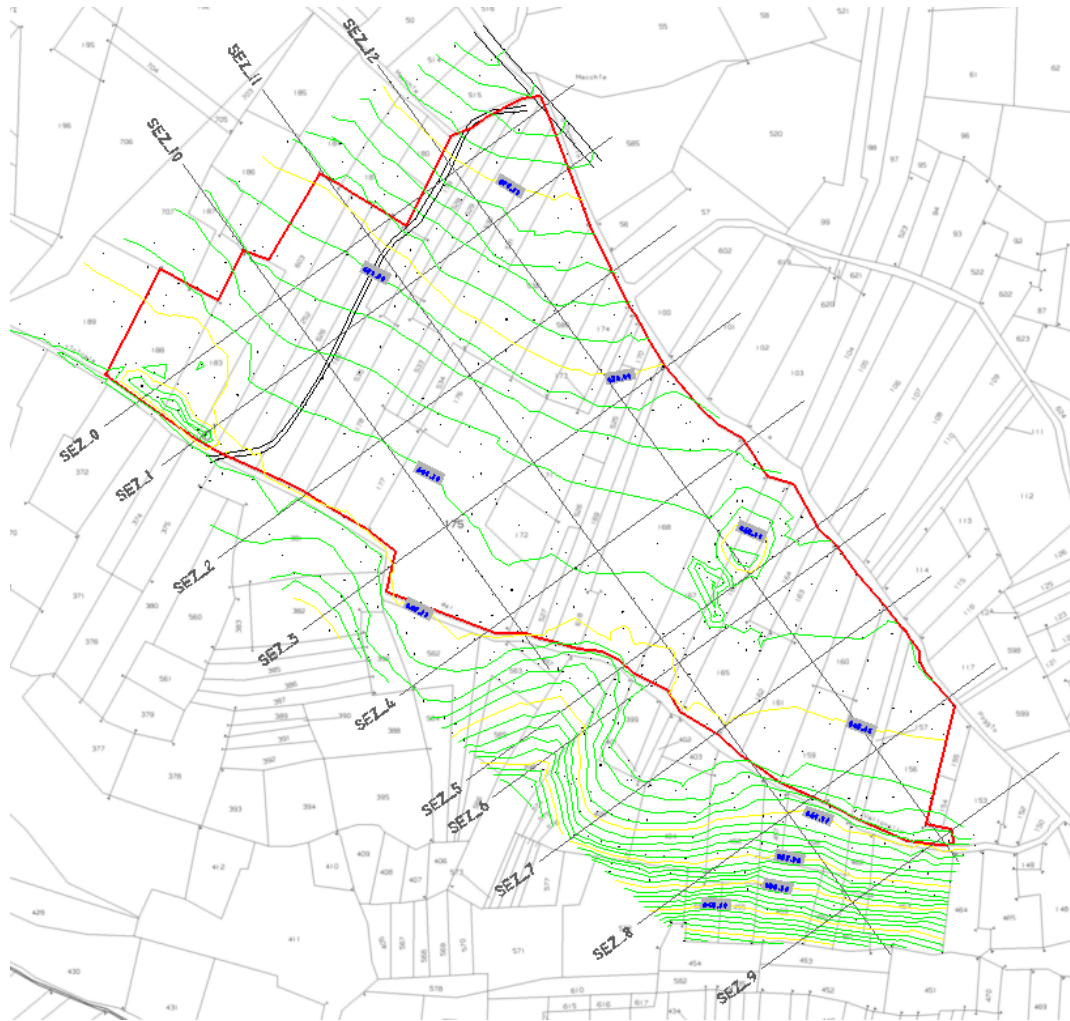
Inquadrimento planimetrico dell'area di intervento
